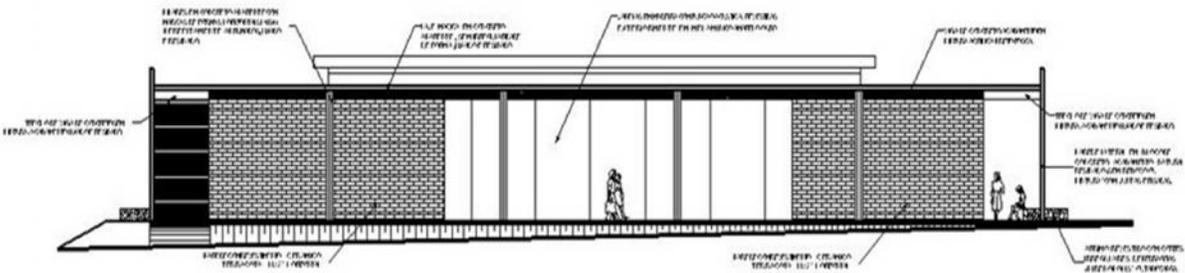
Elevação da prancha original do projeto realizado no software AutoCAD
